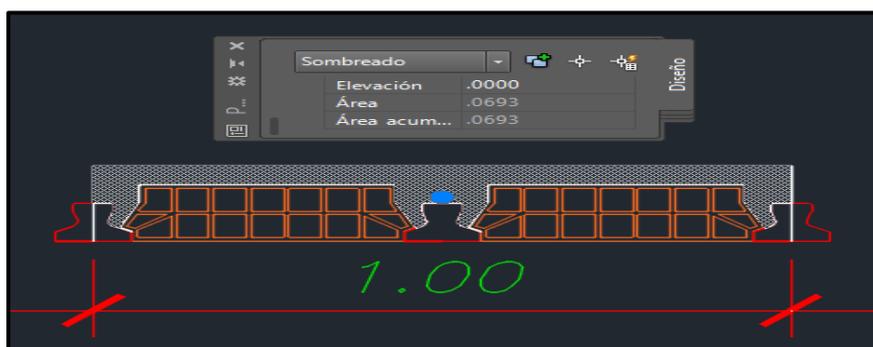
Detalle de consumo de concreto de una losa de 20cm con bovedilla de arcilla.
